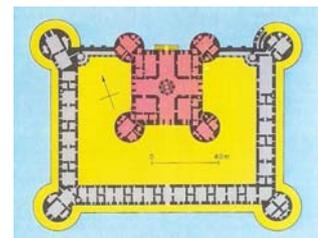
Schloss Chambord, Grundriss, um 1519.
